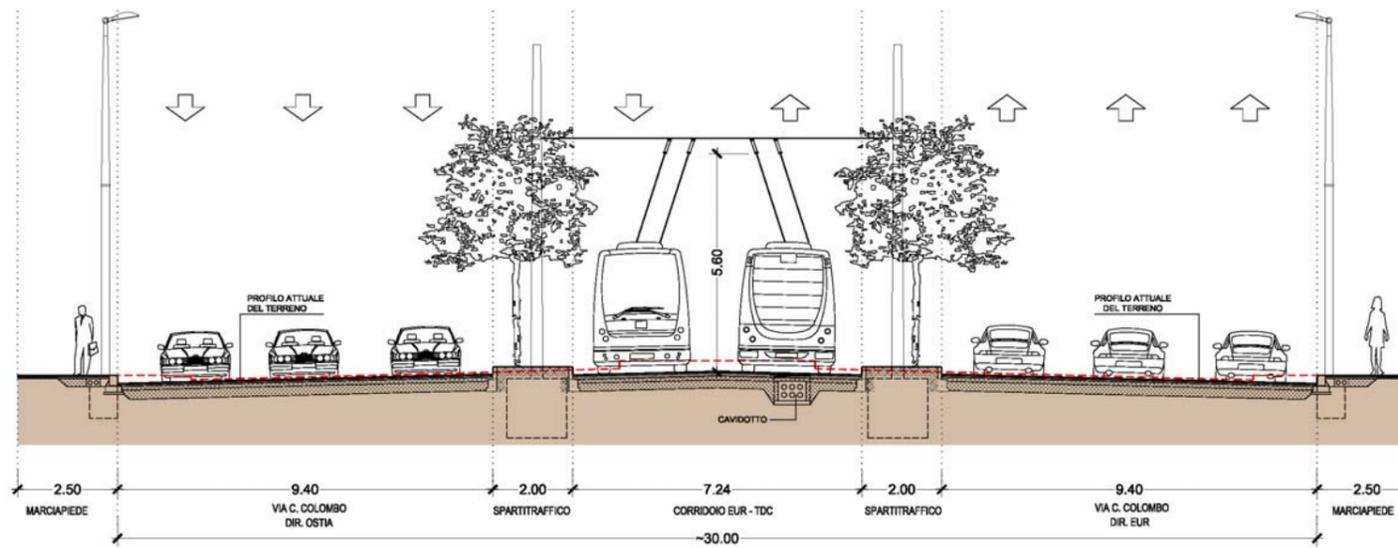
Progetto preliminare approvato 2006 – Sezione tipo
